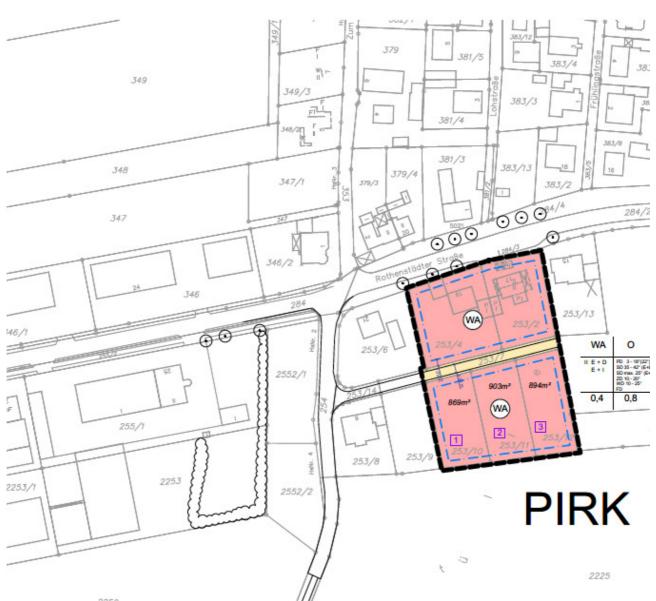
Bebauungsplan (Ausschnitt) /20/, ohne Maßstab
